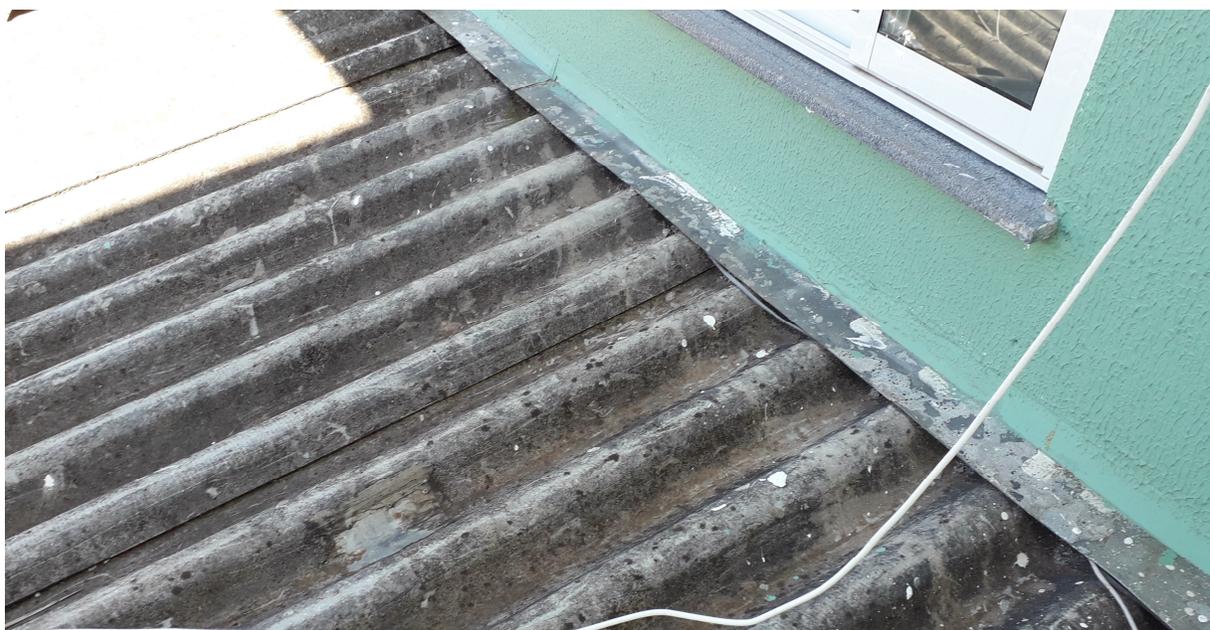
Retirar e recolocar calha na fachada frontal e condutores verticais.
